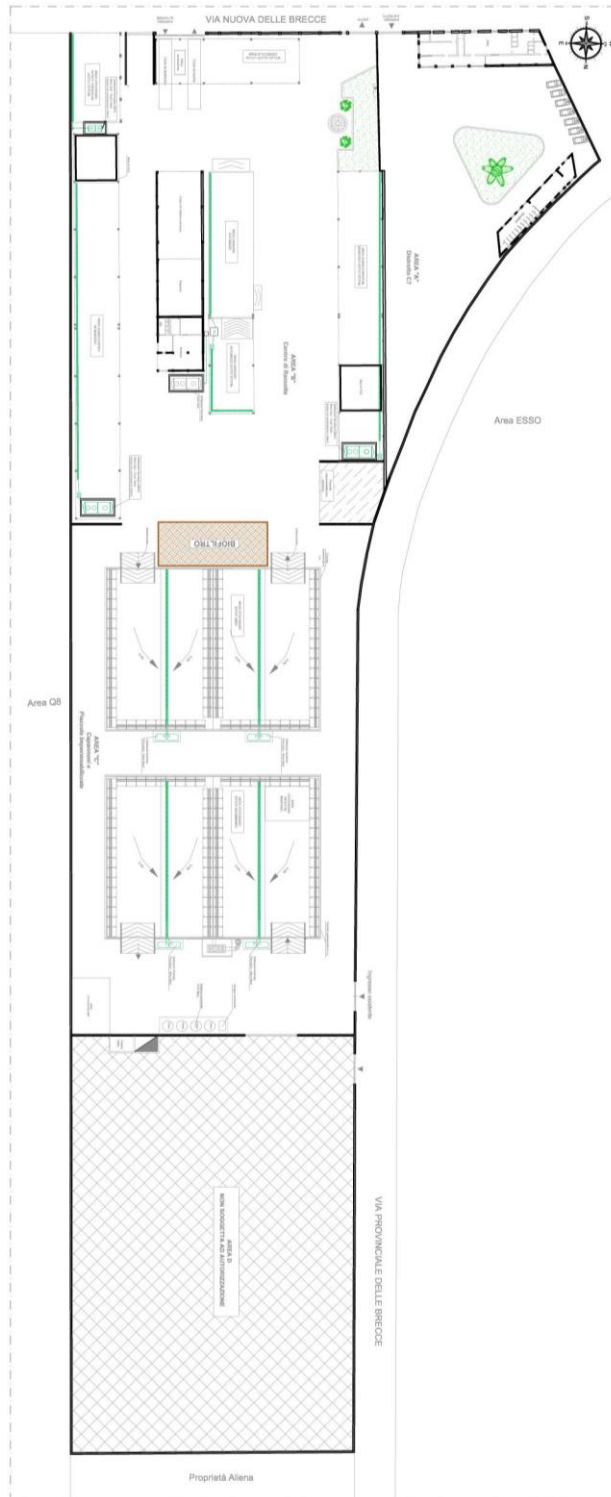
Planimetria Sistema di Raccolta Percolato.
